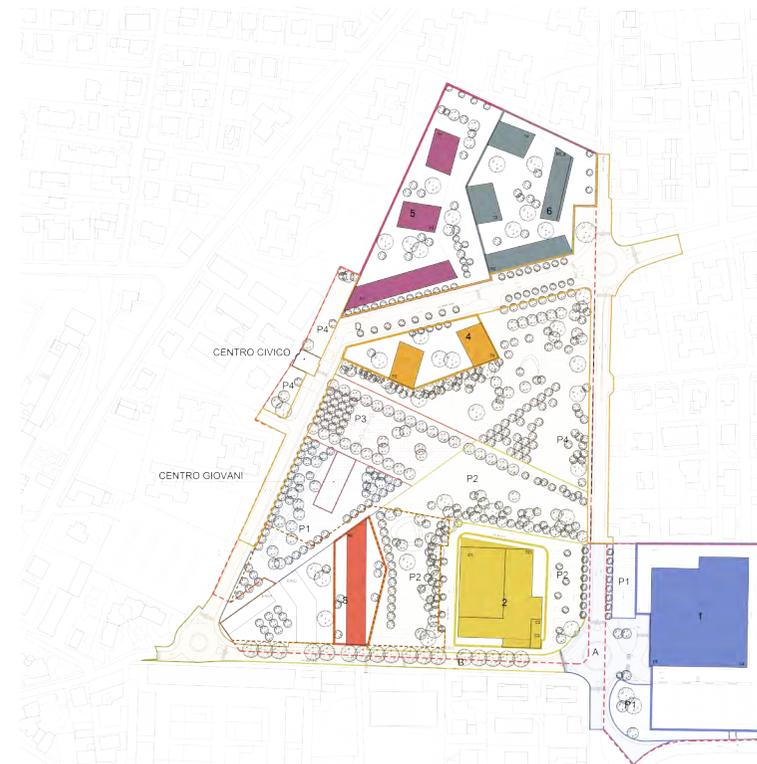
Planimetria generale con individuazione delle fasi di intervento
